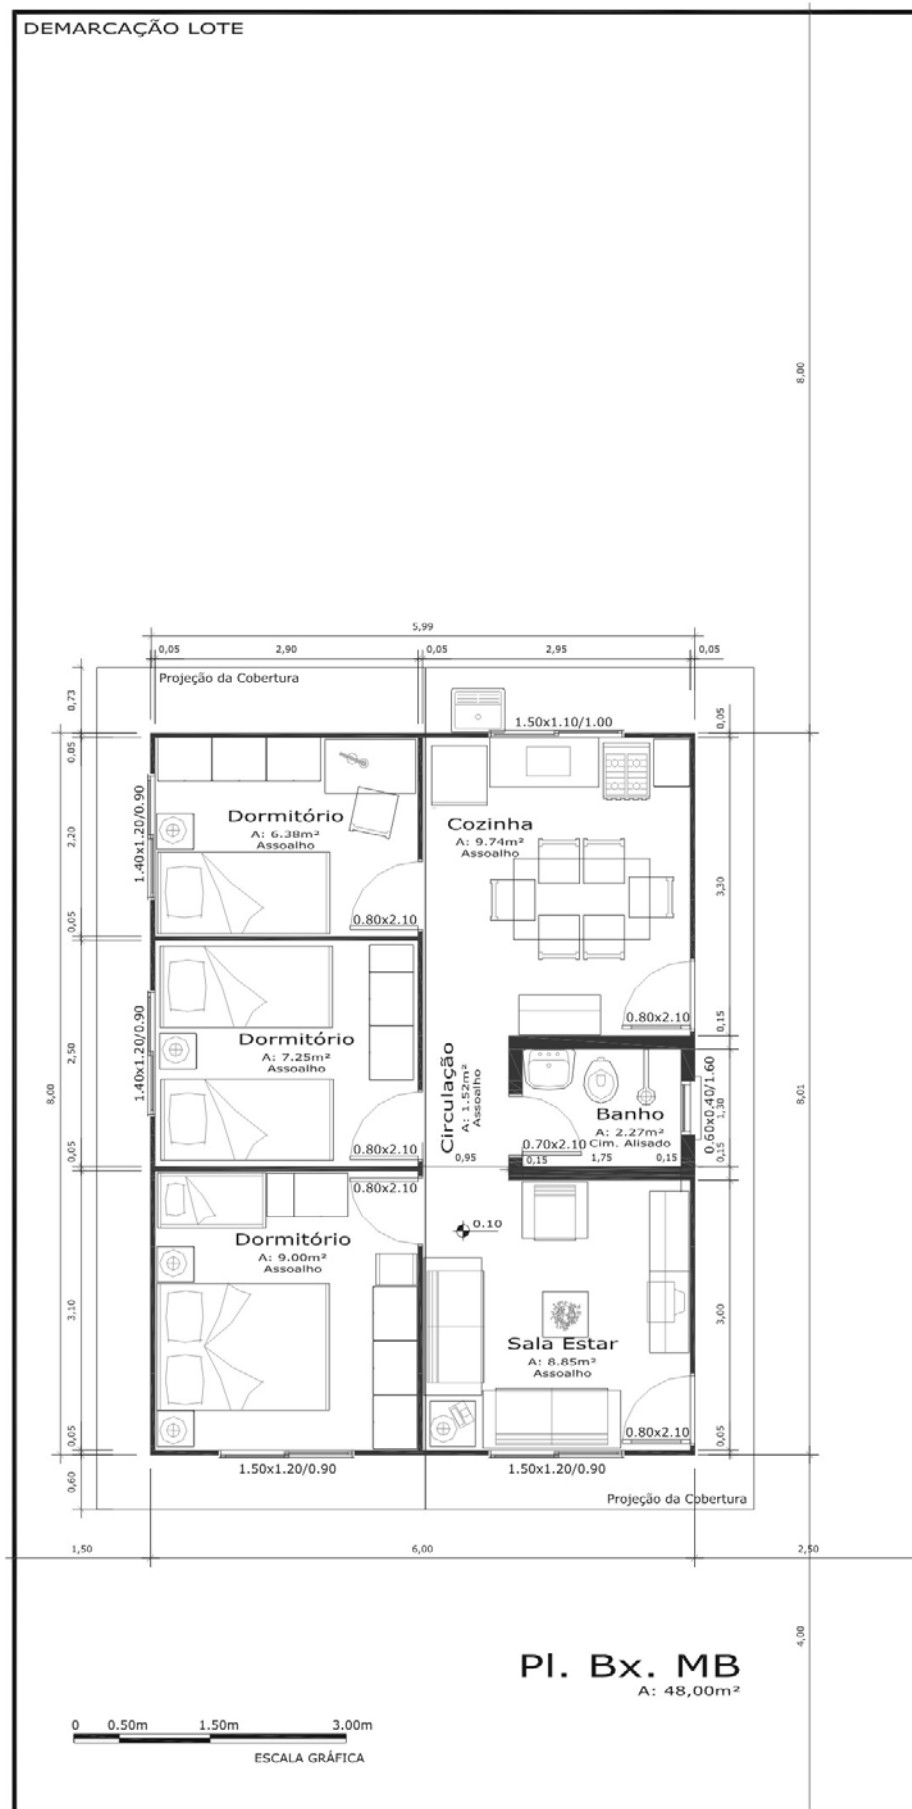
Sistema Construtivo em Madeira, Planta Baixa – Área: 48,00 m².
